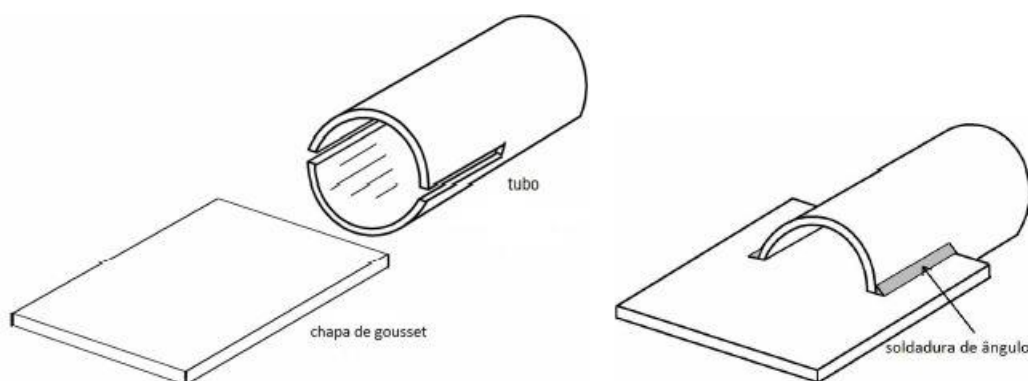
Detalhe do rasgo no tubo a) antes da soldadura; b) depois da soldadura, [41].
